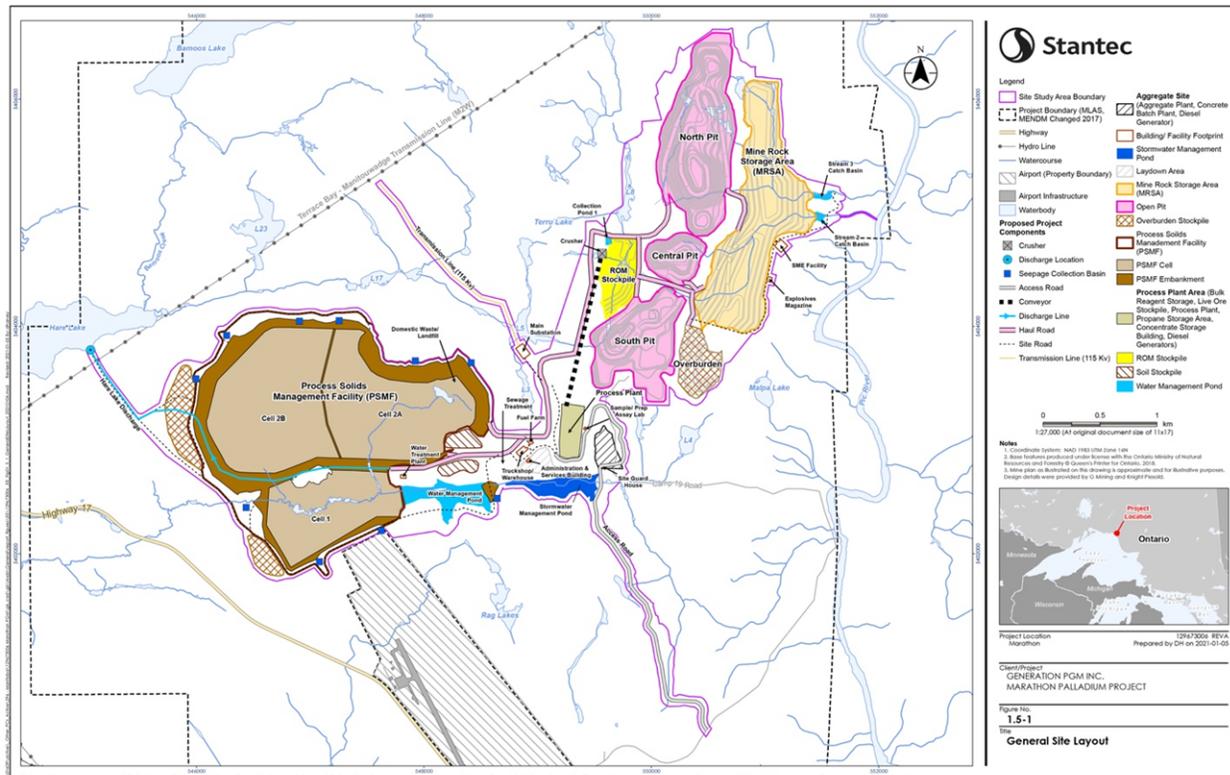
Plan d'implantation générale du site (source : RCEI n° 727)
